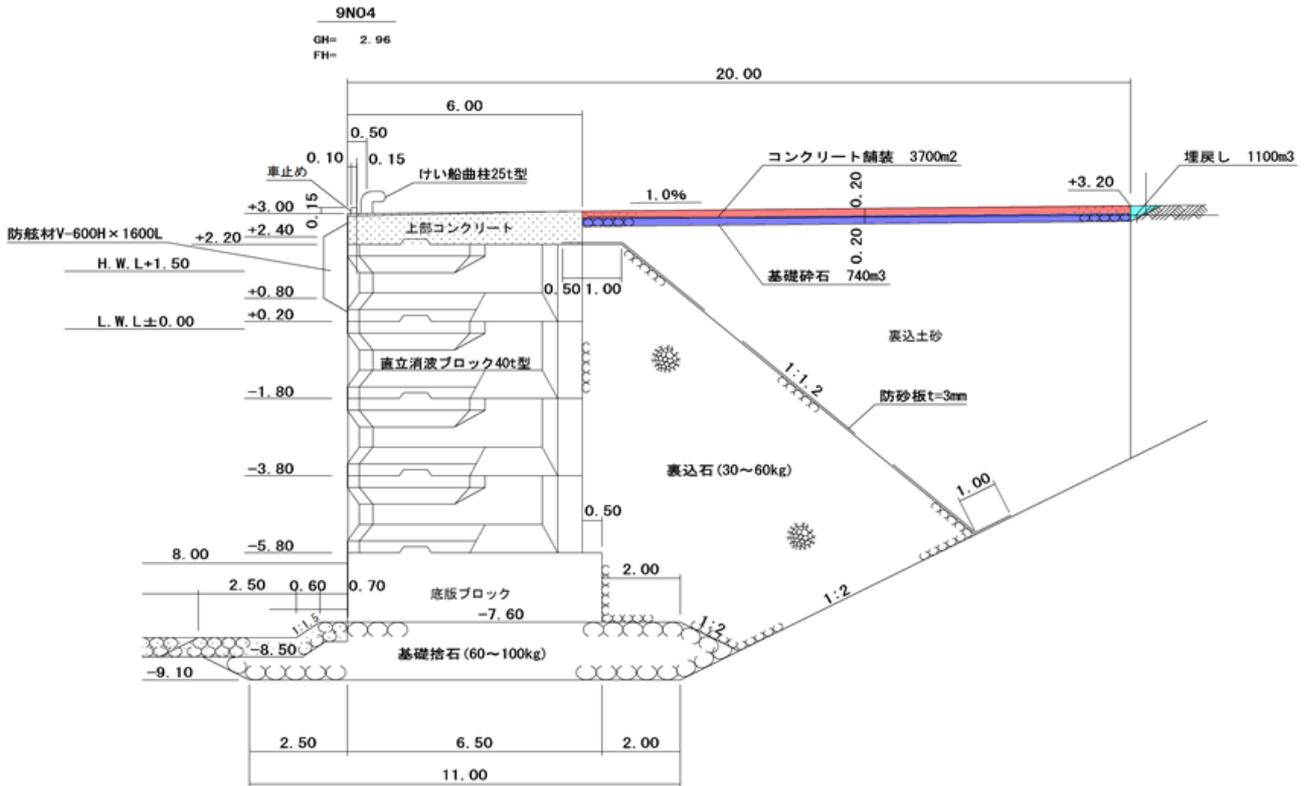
No.34 大洗港区_第3埠頭地区西岸壁 (-8m) の断面図 (復旧後)
